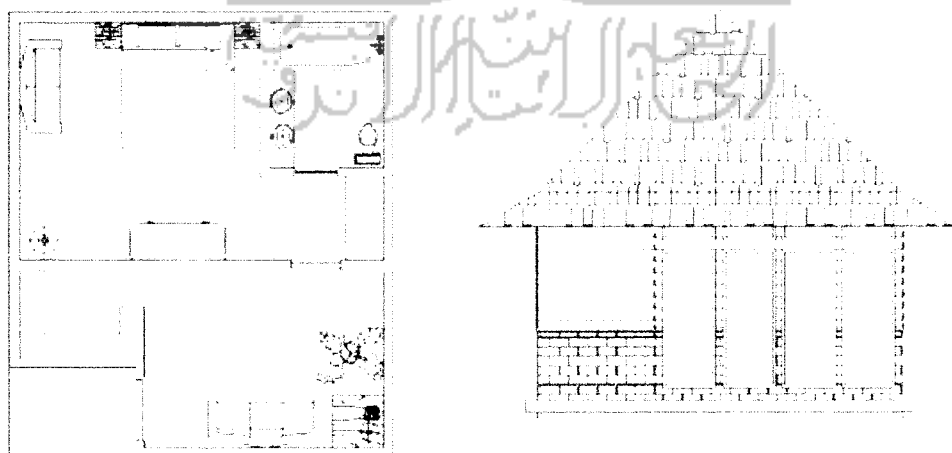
Tampak Bangunan Penginapan Type Deluxe
